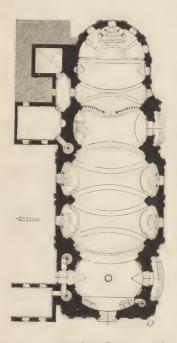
St. Margareth in Břevnov. Grundriss.
